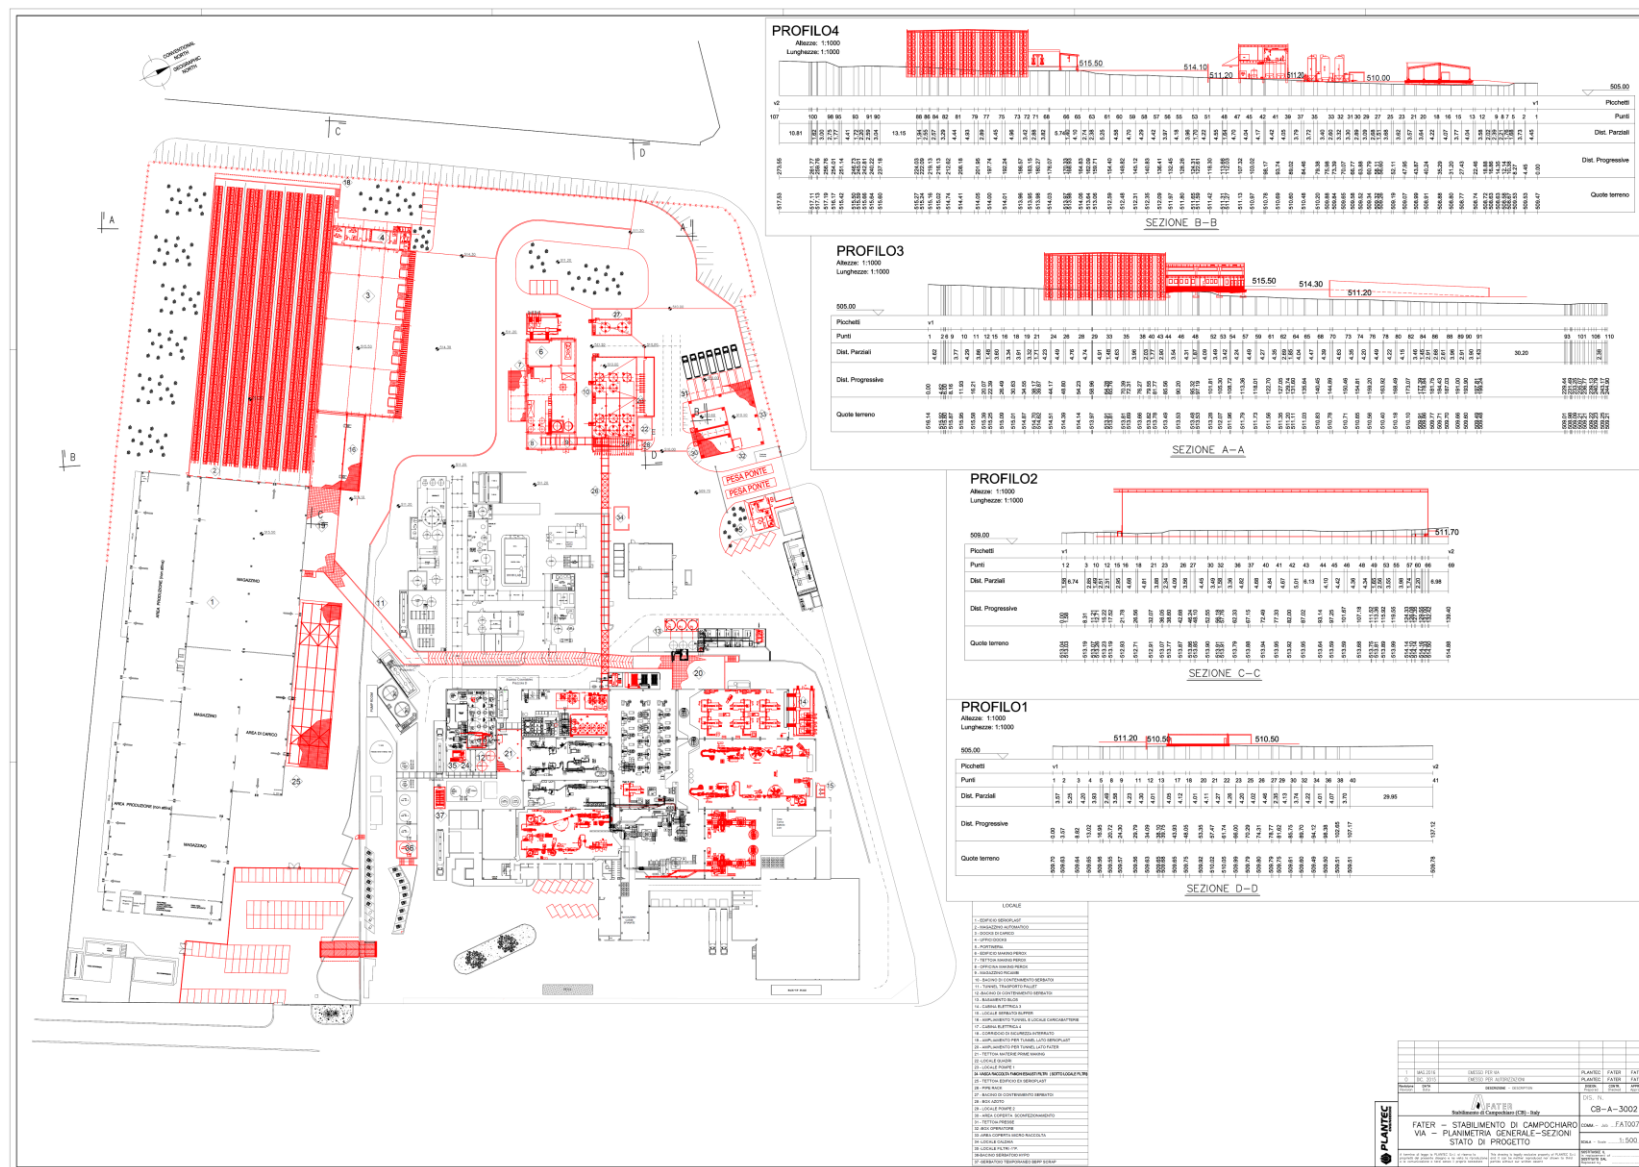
planimetria generale dell'impianto: assetto "post operam"
